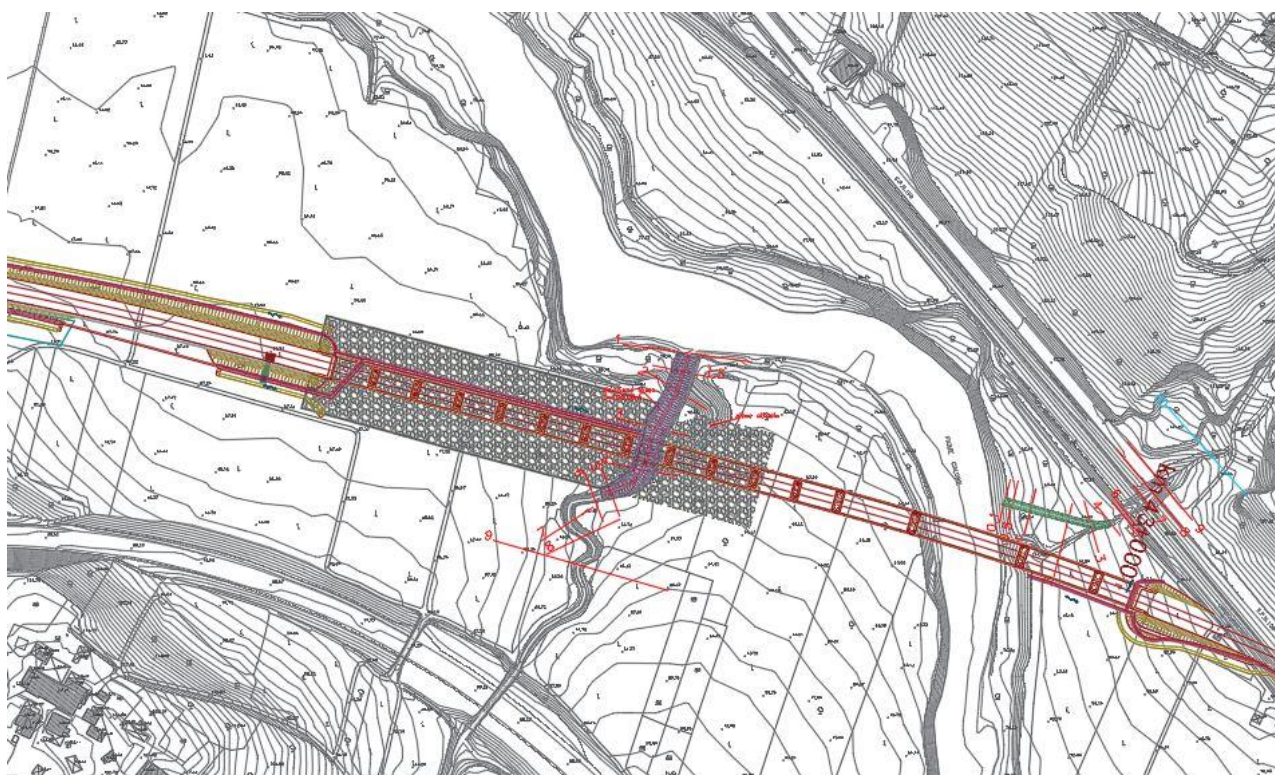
Stralcio planimetria di progetto del Fosso Scafamelia
